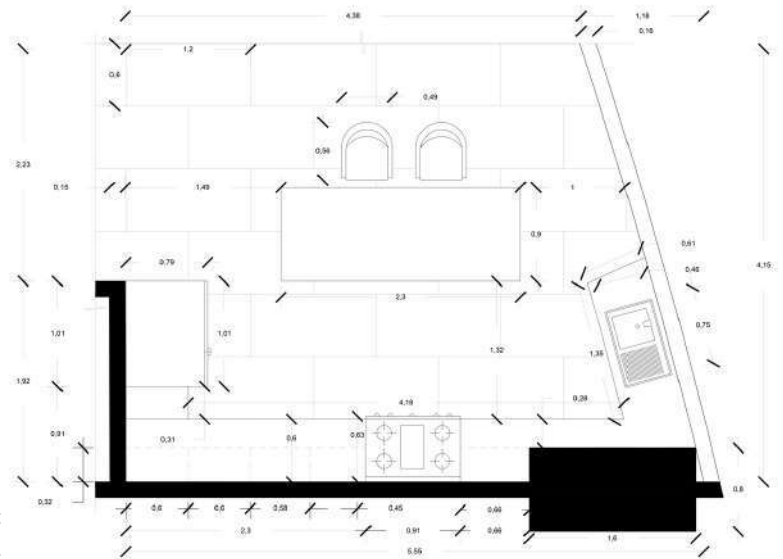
Planta de cocina acotada. Fuente: Autoría propia.
